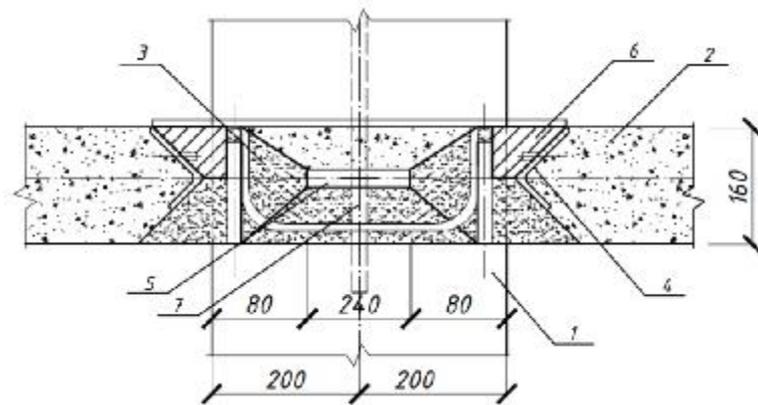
Конструкция усовершенствованного стыка соединения надколонной плиты с колонной:
